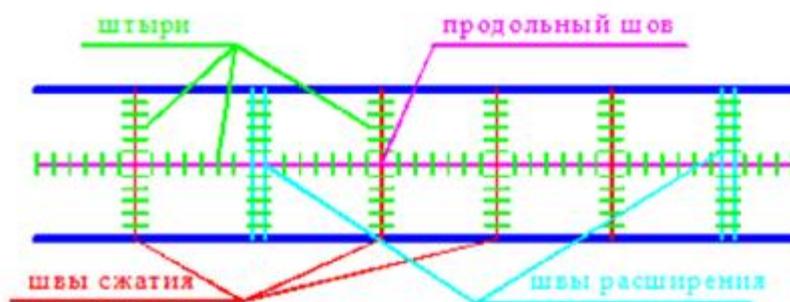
Схема швов в цементобетонных покрытиях
